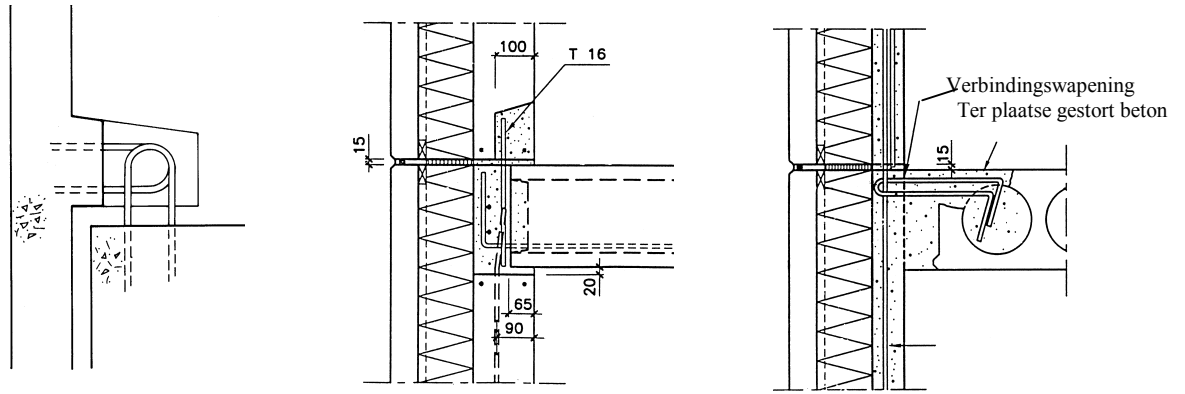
Voorbeelden van verbindingen met wachtstaven en ter plaatse gestort beton
